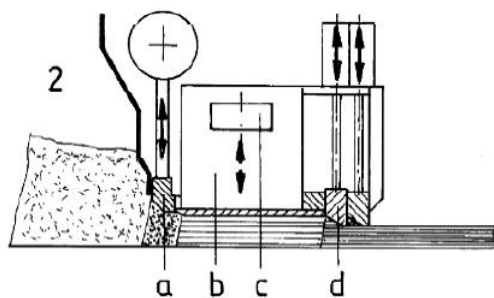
Bauteile des Einbaufertigers⁷⁴
